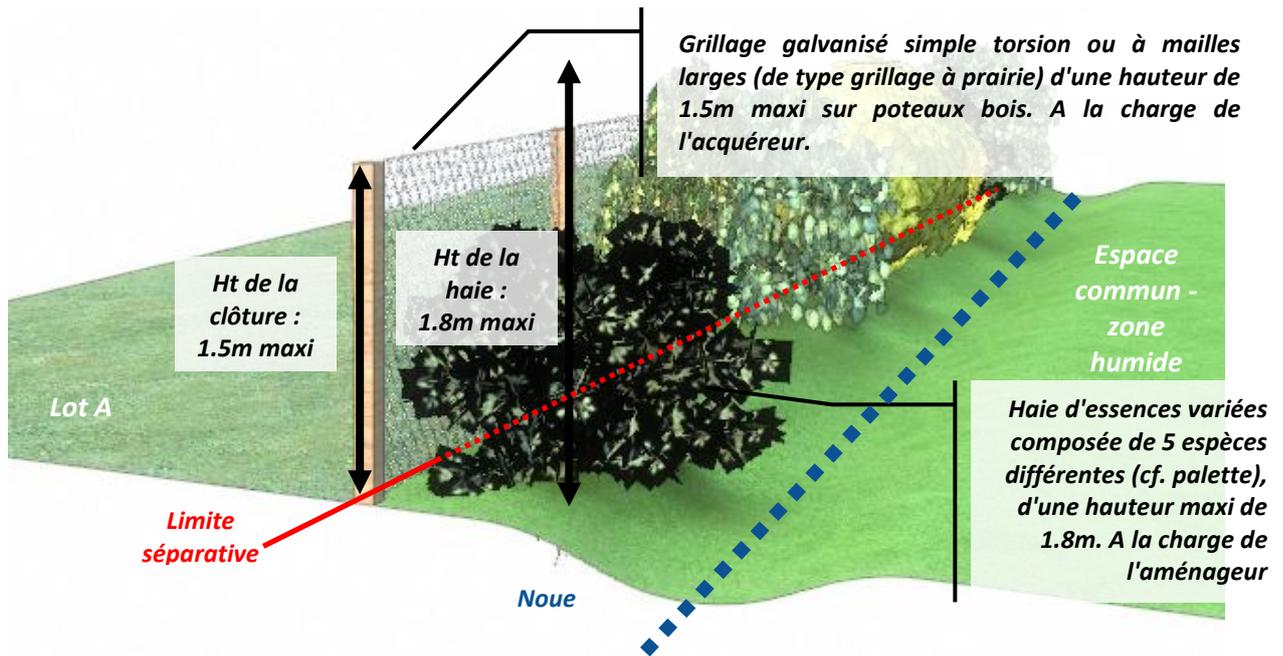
Maquette 3D du rendu concernant la haie et la clôture en bordures de zone humide et d'un espace commun dans le d'un grillage de type "prairie"
